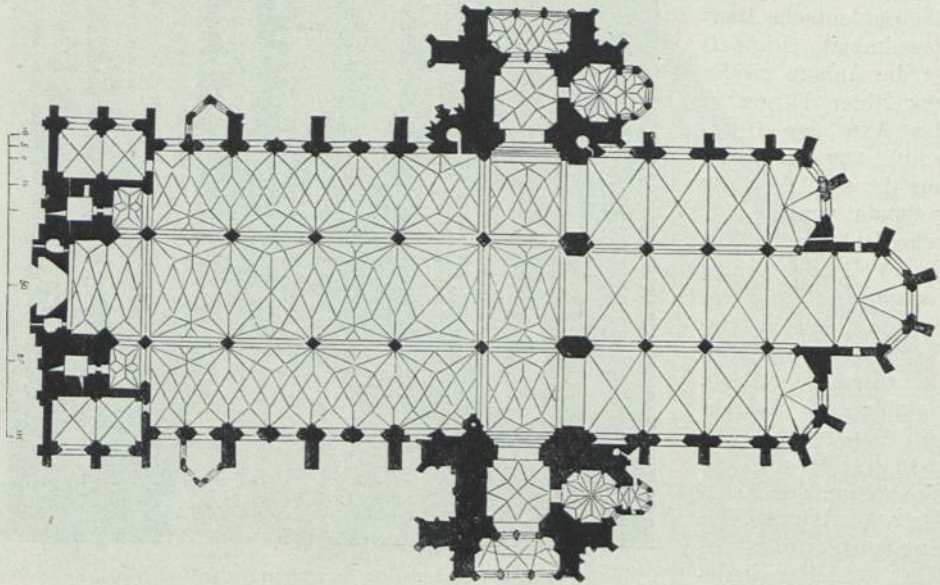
Grundriss von St. Stephan zu Wien
